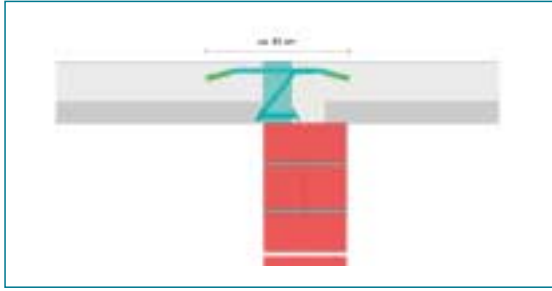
Conexiones voladizas con armadura de compuesto de alto rendimiento.
